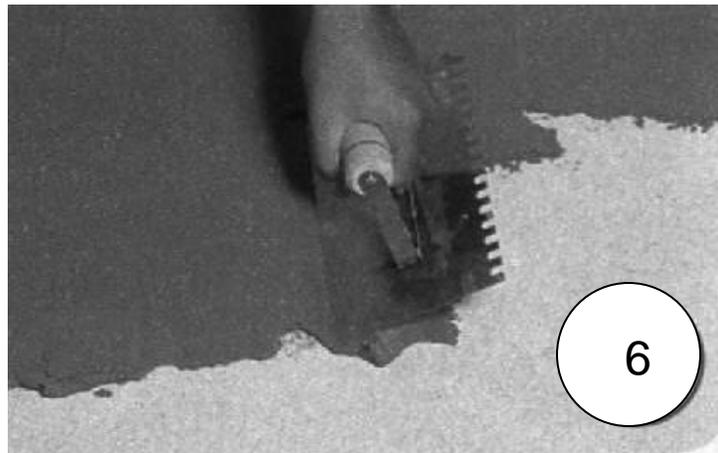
Aplicação da argamassa no piso com o lado liso da desempenadeira.
